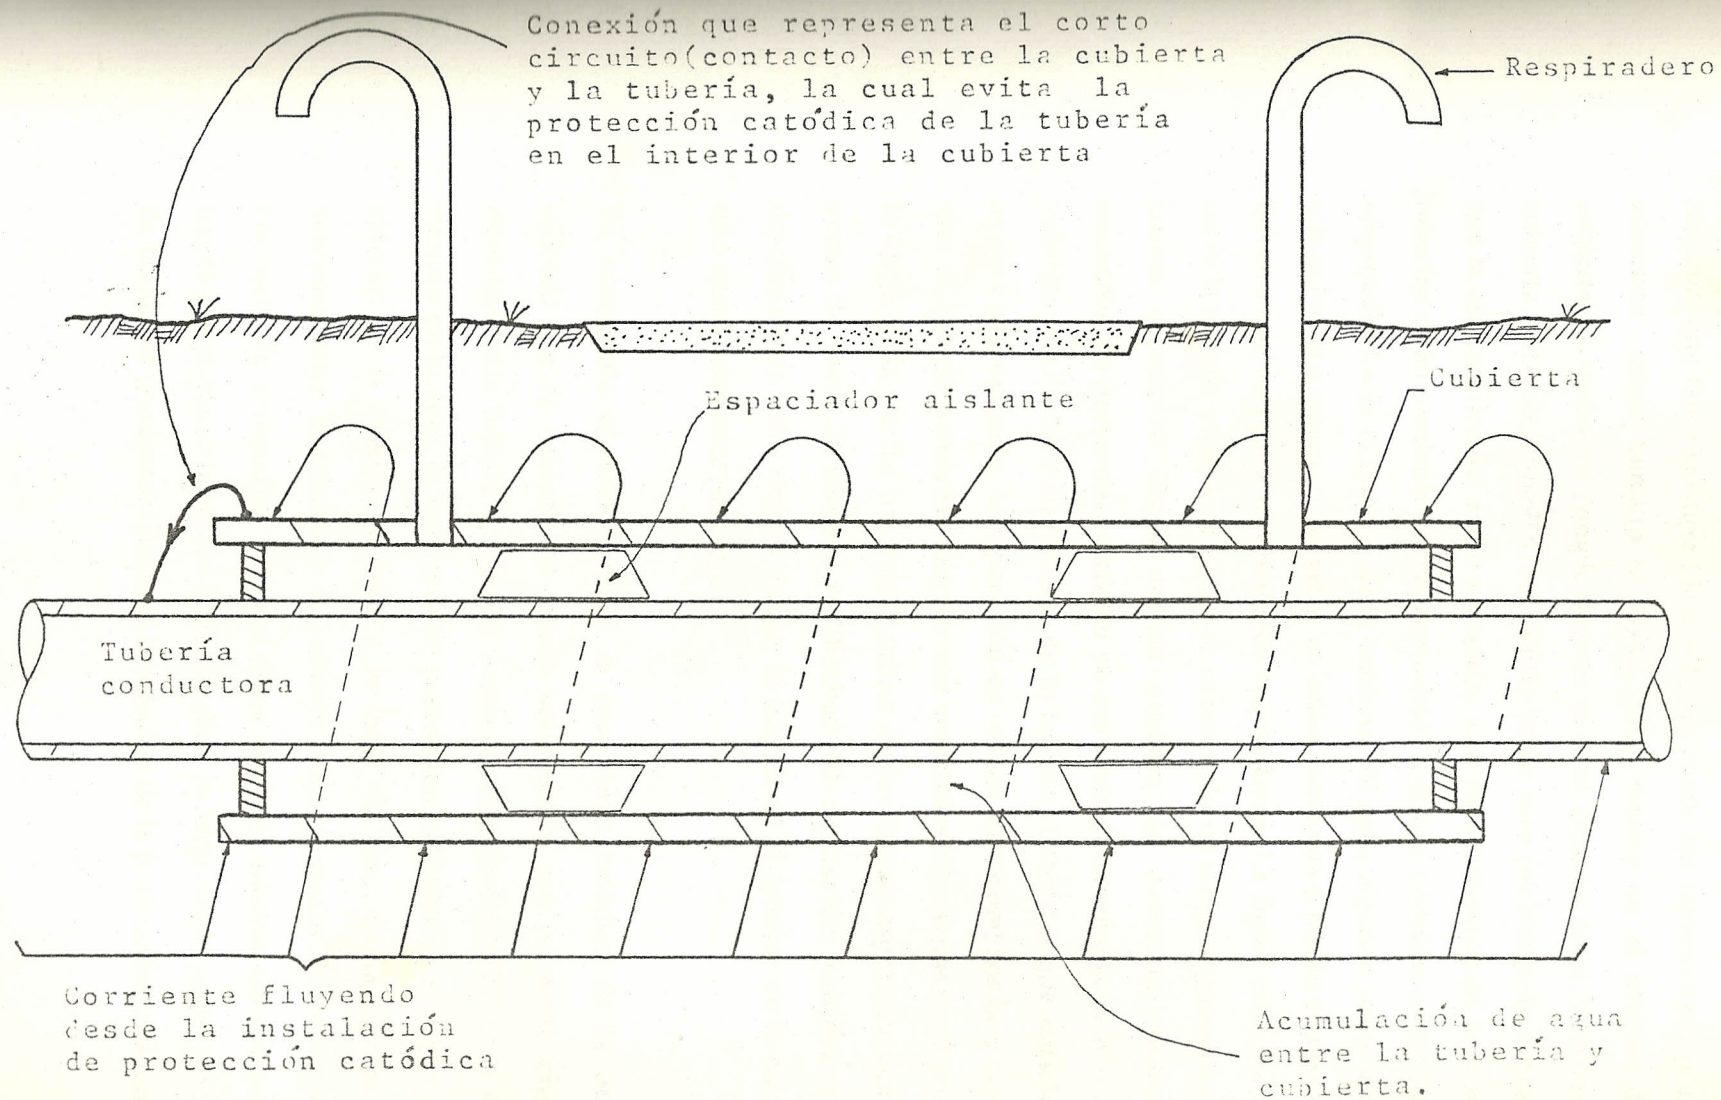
Aislamiento eléctrico por cubierta corta
